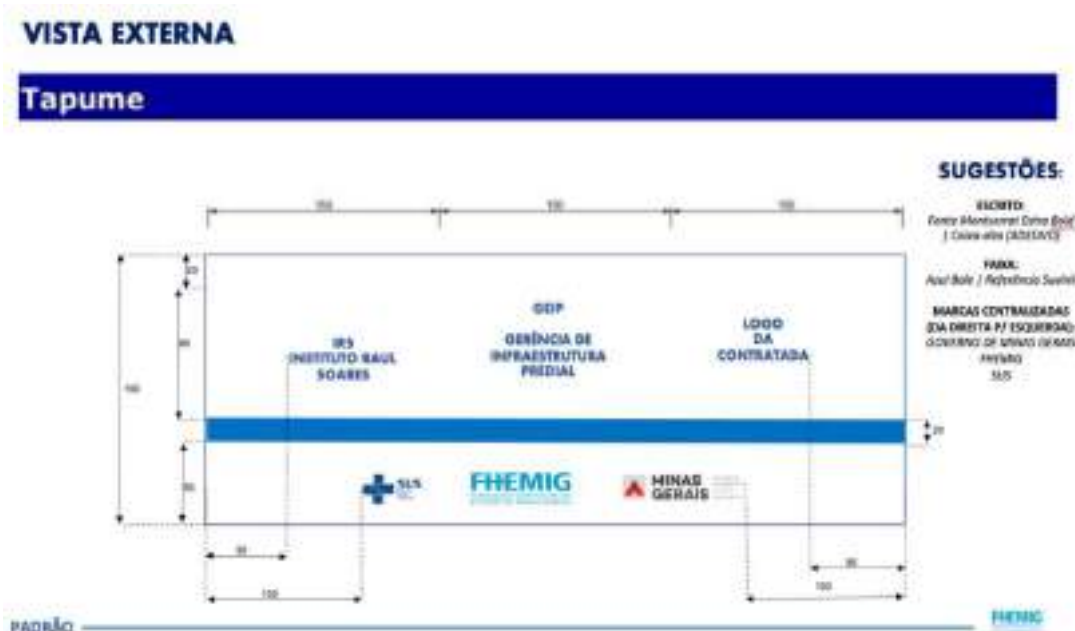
REF | Canteiro Inteligente – Espaço adaptado
